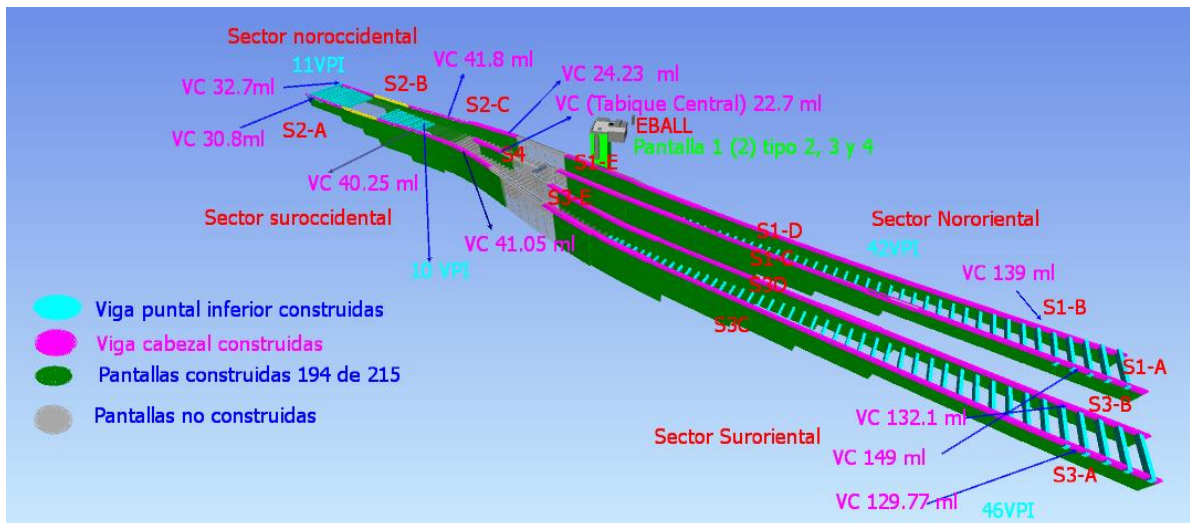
Esquema 3D muros pantalla, vigas puntal y vigas cabezal ejecutadas.
